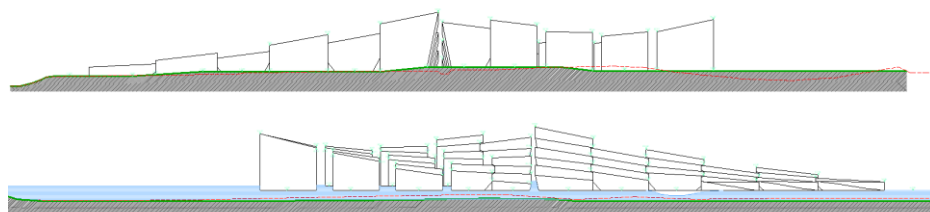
Perfis nascente e poente do loteamento proposto (Fonte: EIA – julho de 2021).
